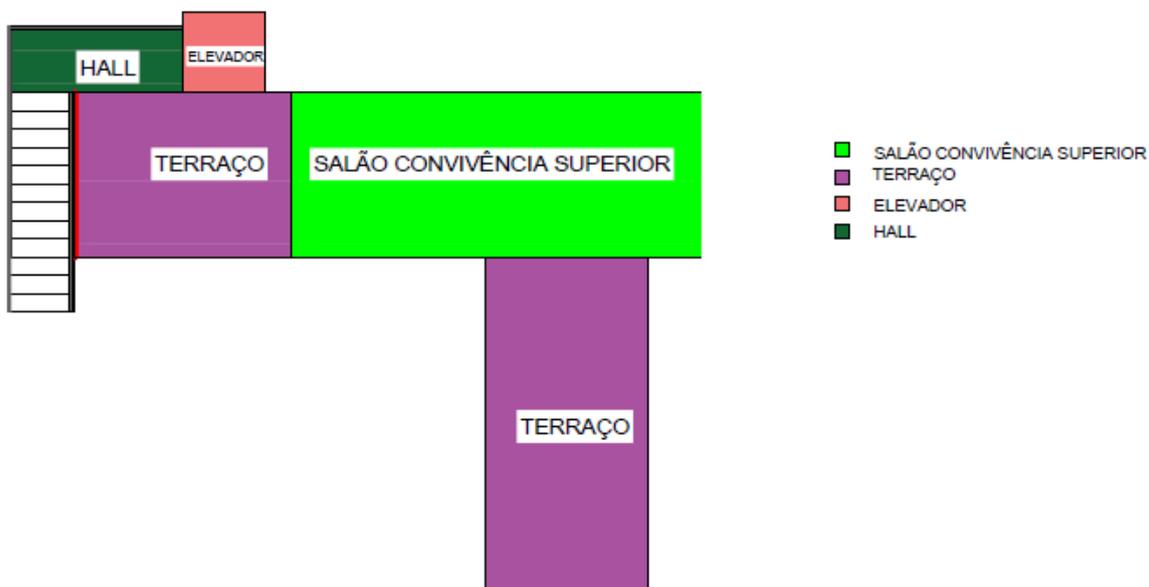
Setorização Caixa do Açai – Pavimento Superior.
